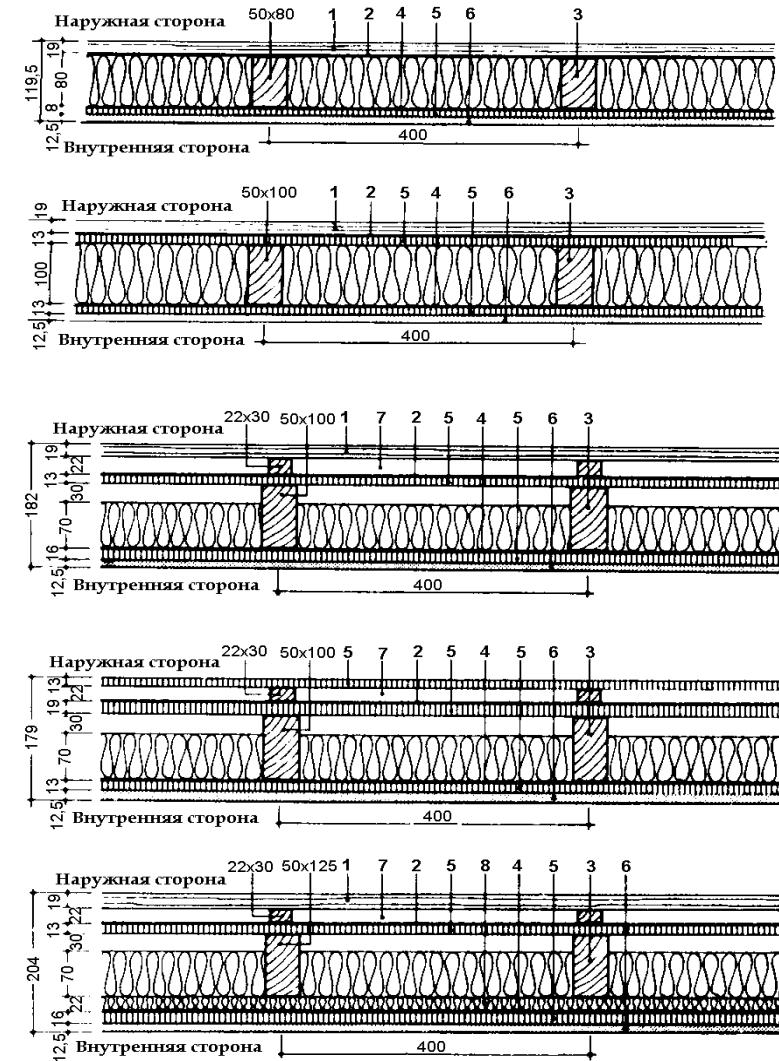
Варианты устройства наружных стен каркасных зданий.
